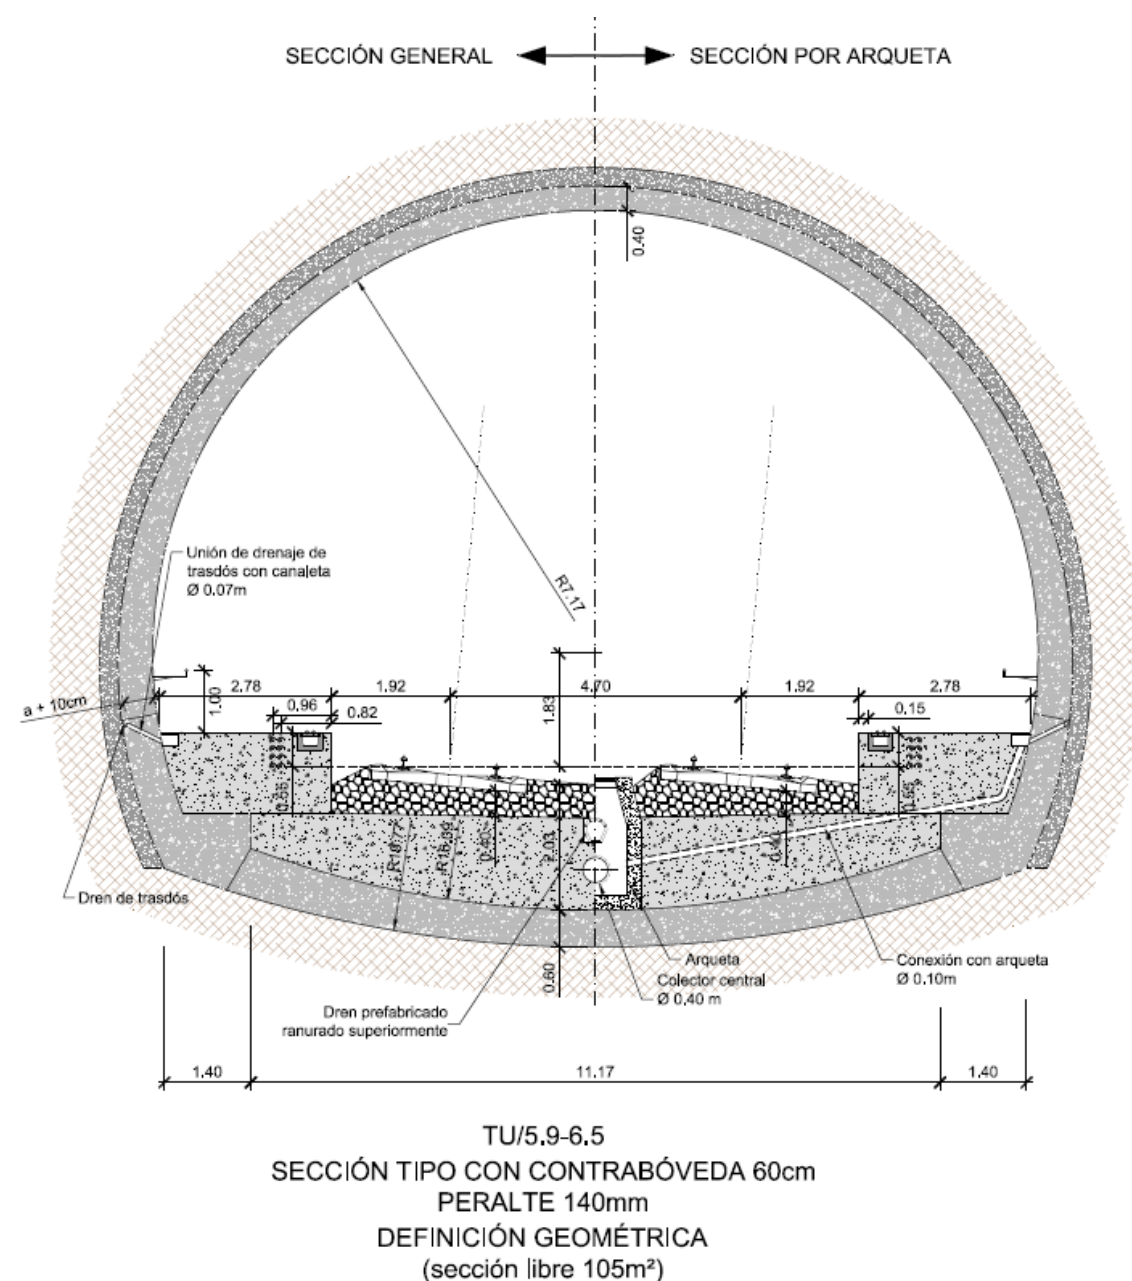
Sección tipo túnel de Ameyugo II. Fuente: Proyecto constructivo 2013
